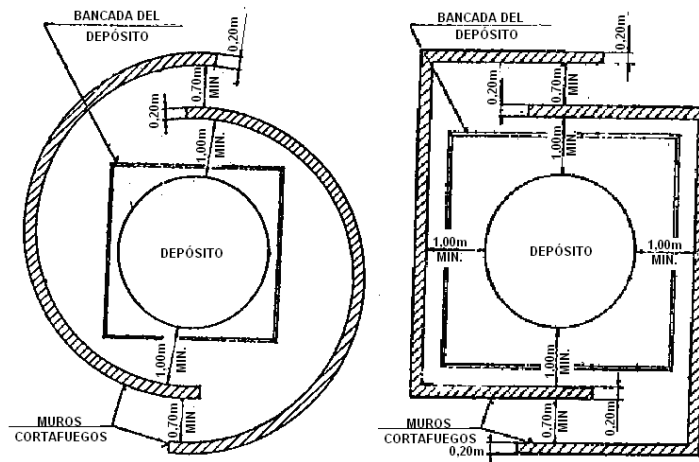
Muros de perfil autoventilante. Fuente: ITC MIE-AP10. Ministerio de Trabajo y Asuntos Sociales. España.
